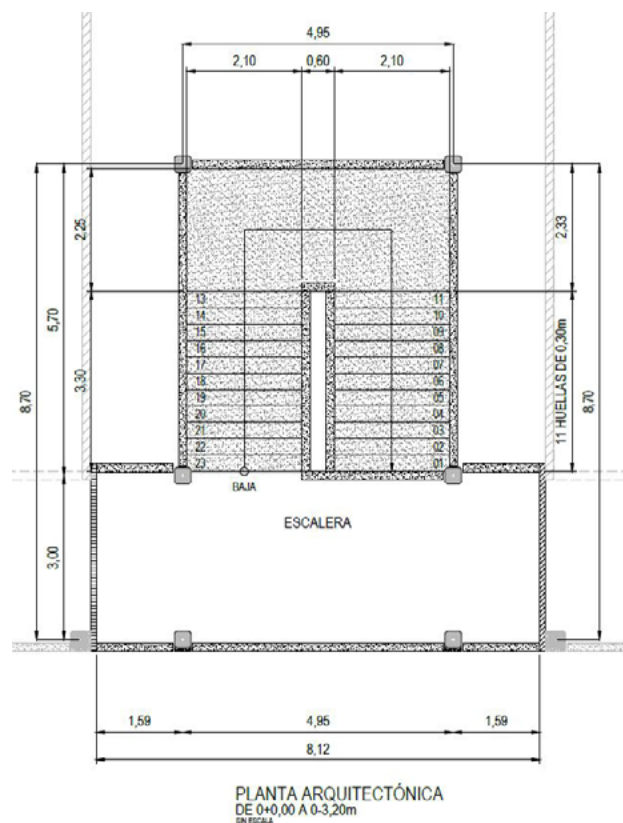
Módulo de escalera pabellón elevado. Fuente: DIEE (2018).
